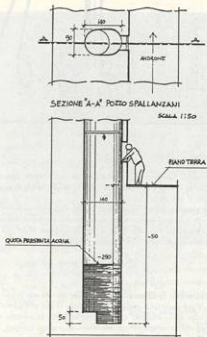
Planta Pozzo Spallanzani.
